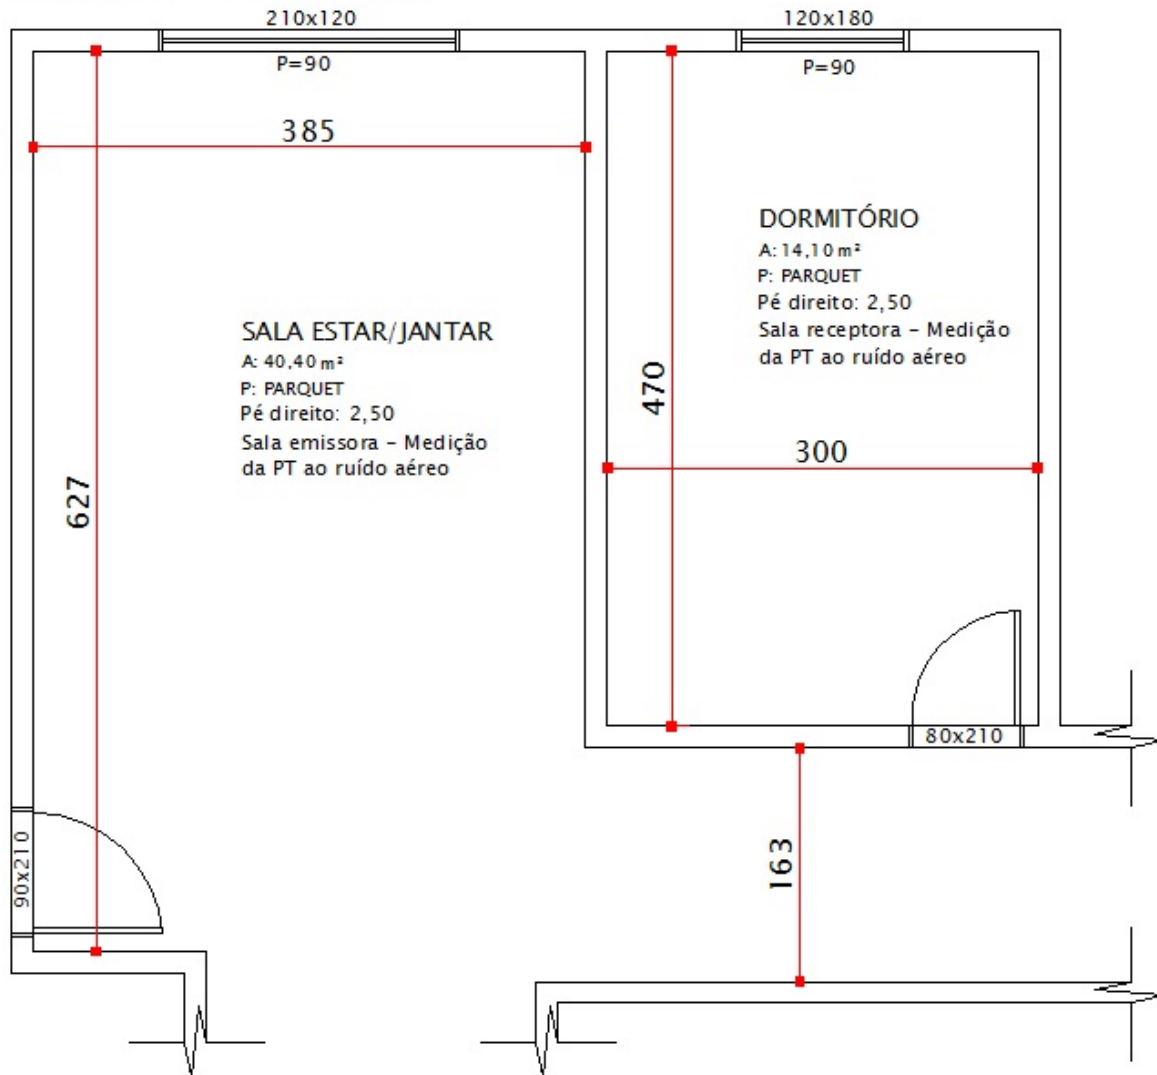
Planta baixa - pavimento tipo - 04-PIS-TV
